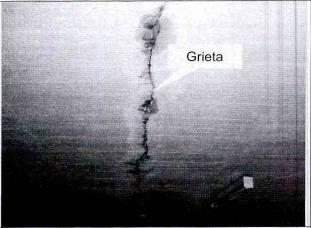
Vista de la cara inferior de la placa aérea de la estructura de sótano; donde se observa las grietas de tendencia irregular.
